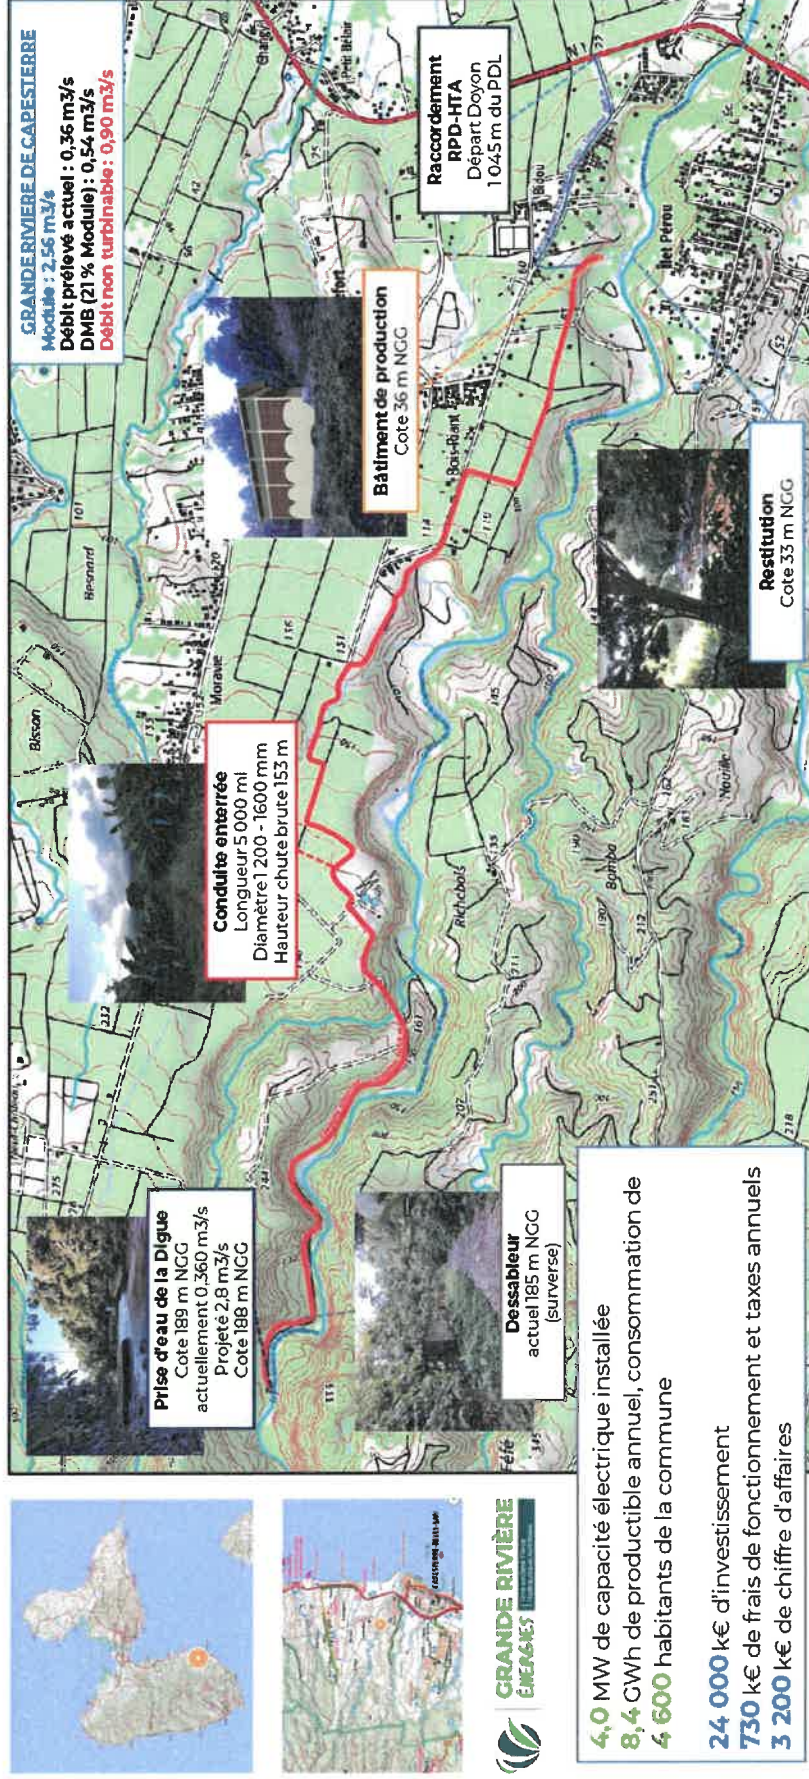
Plan de situation illustré du projet (conduite enterrée en rouge)
